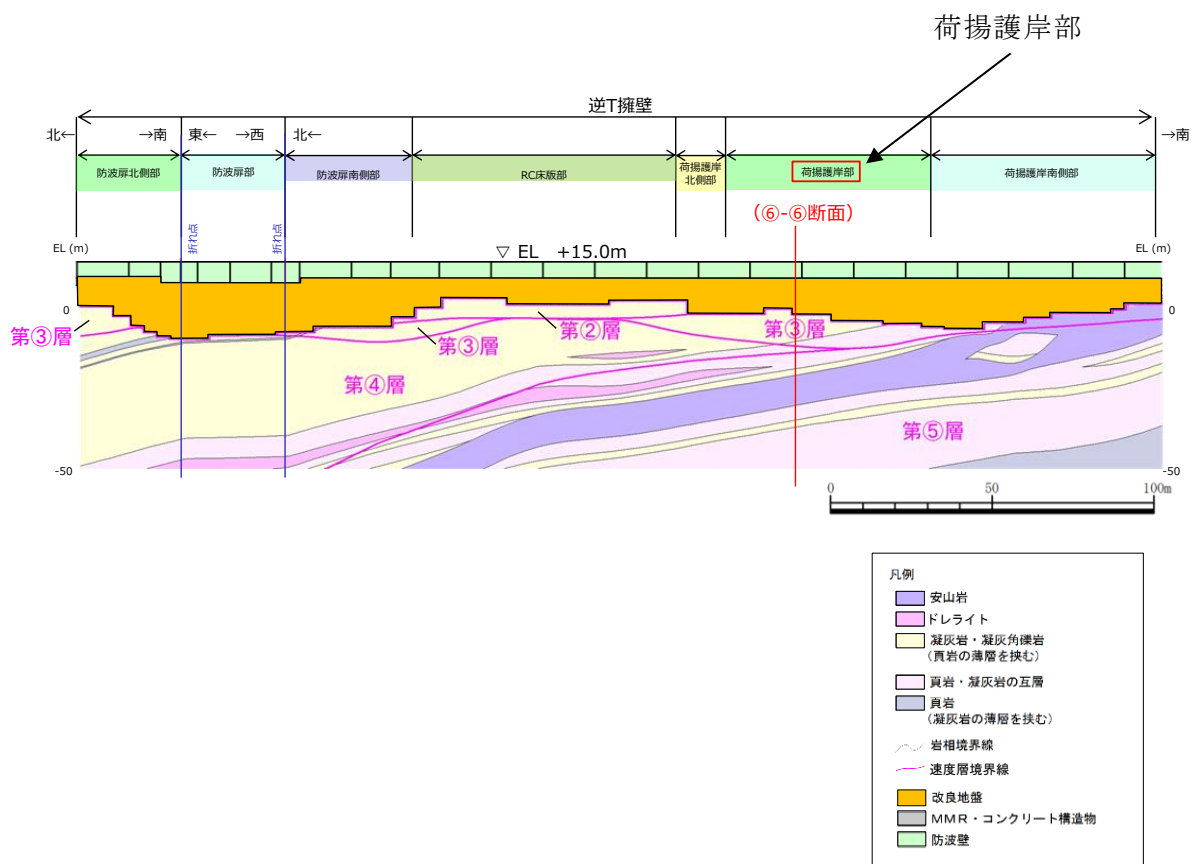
(2) 防波壁（逆 T 擁壁）の地質縦断面図（岩相図）
